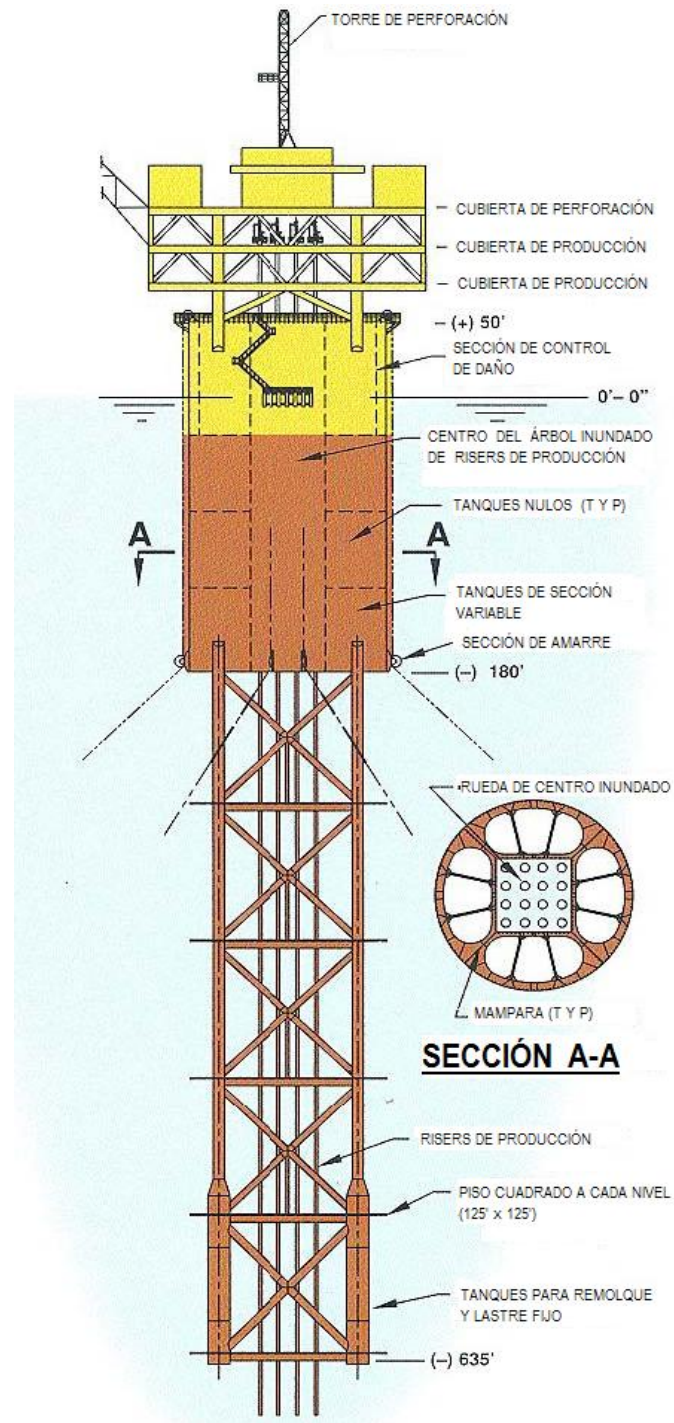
Plataforma tipo Spar Truss (Spar International Inc. 1997) (Fuente: www.pemex.com).
